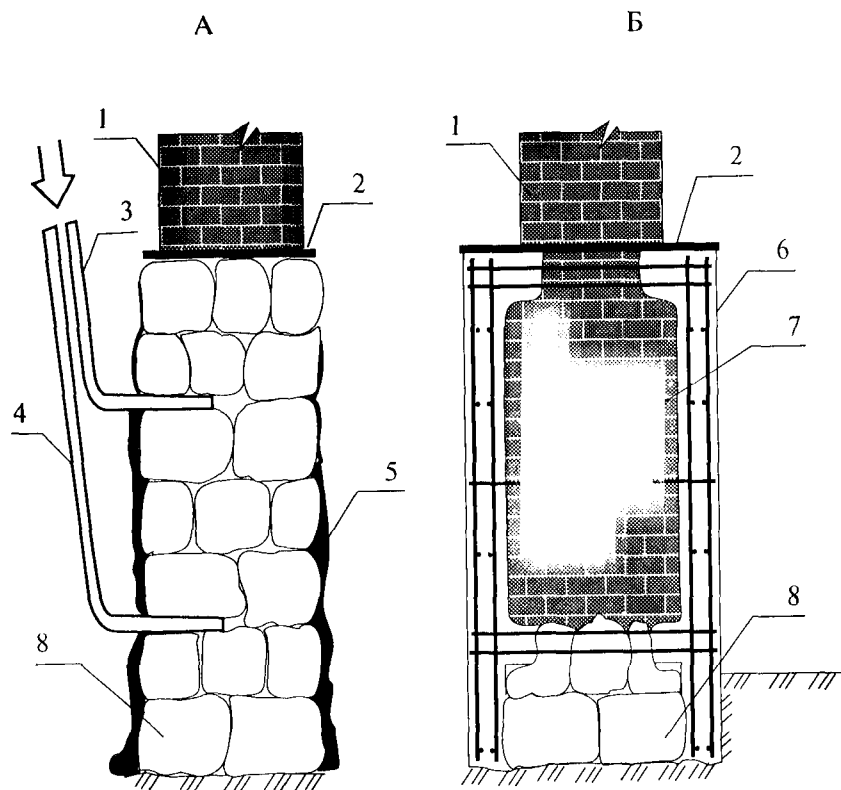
Усиление бутового фундамента и стен подвала
